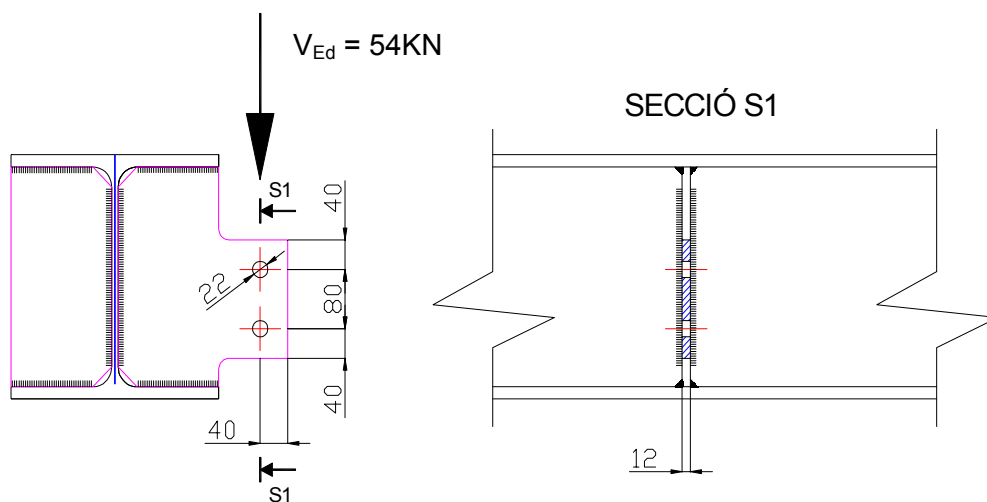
Vista i secció de la plaques d'unió jàssera-corretja
